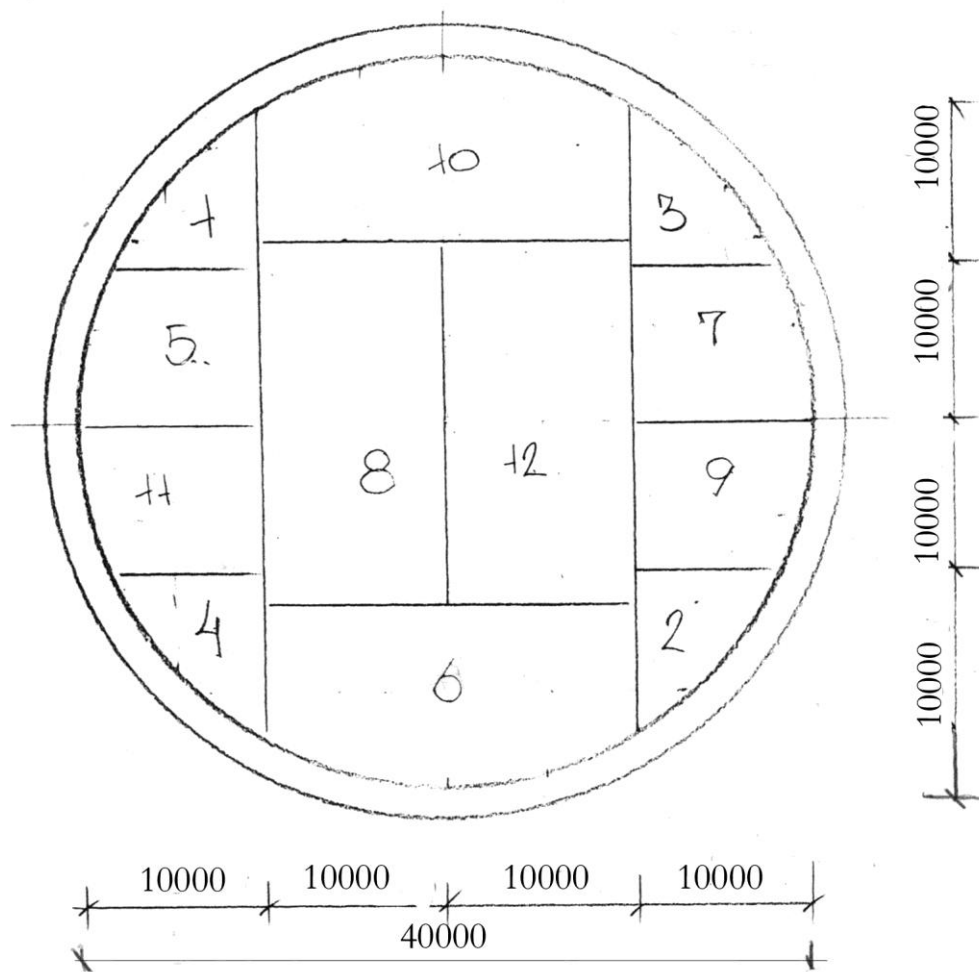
Послідовність укладки другого шару бетону в днище діаметром 40м.
